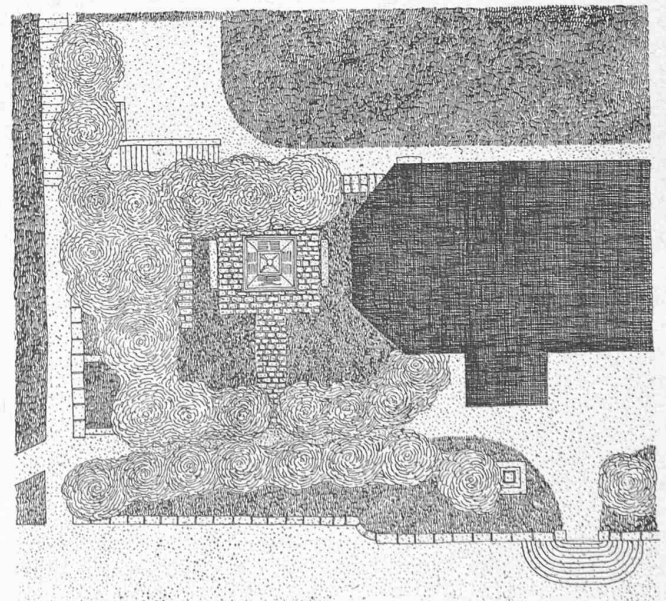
Lageplan der beiden Denkmäler bei der Kirche Langnau. — 1:500.
